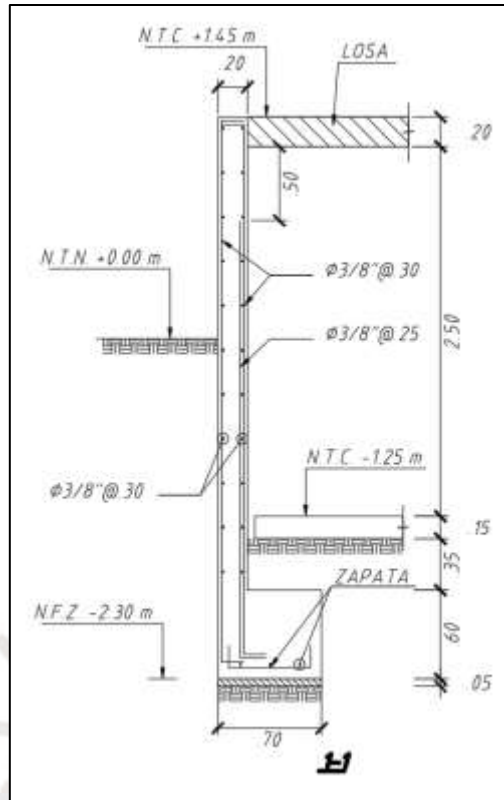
Disposición de los aceros colocados en una sección del muro de sótano
